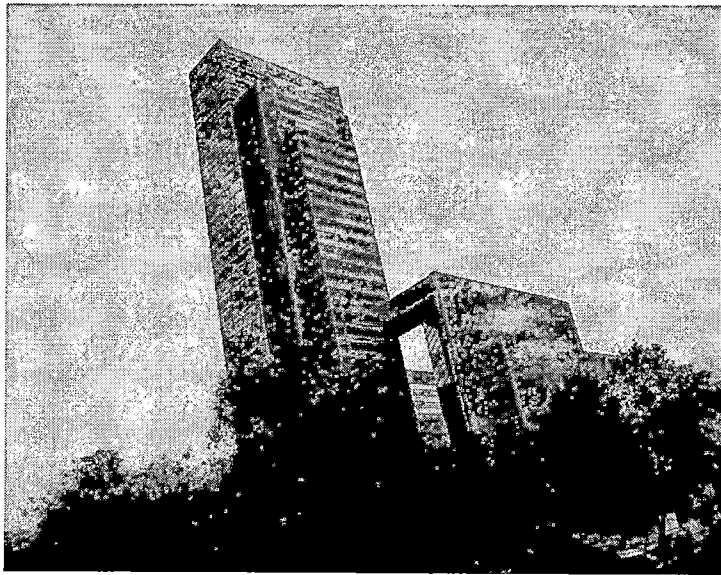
y 14: Uso de encofrado metálico. Fuente: Propia
